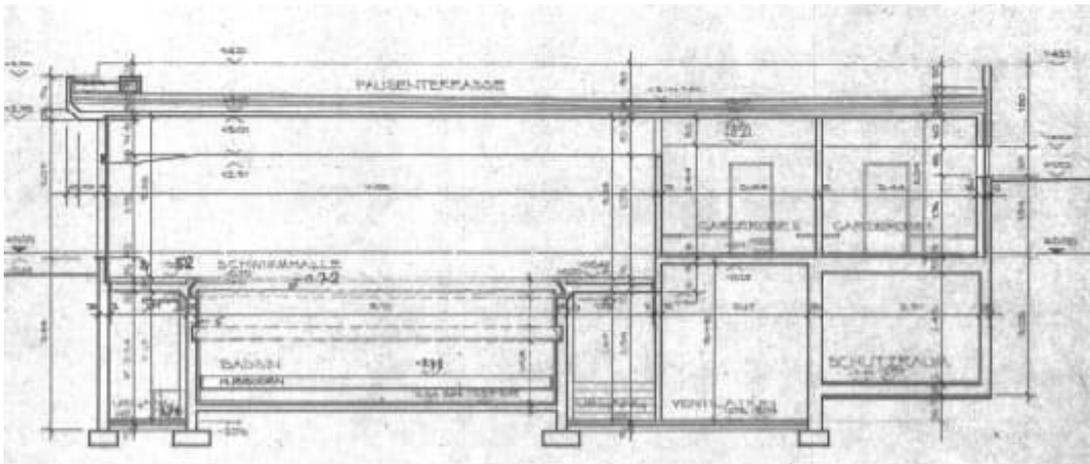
Planausschnitt «Fassaden» mit Querschnitt Lehrschwimmtrakt
